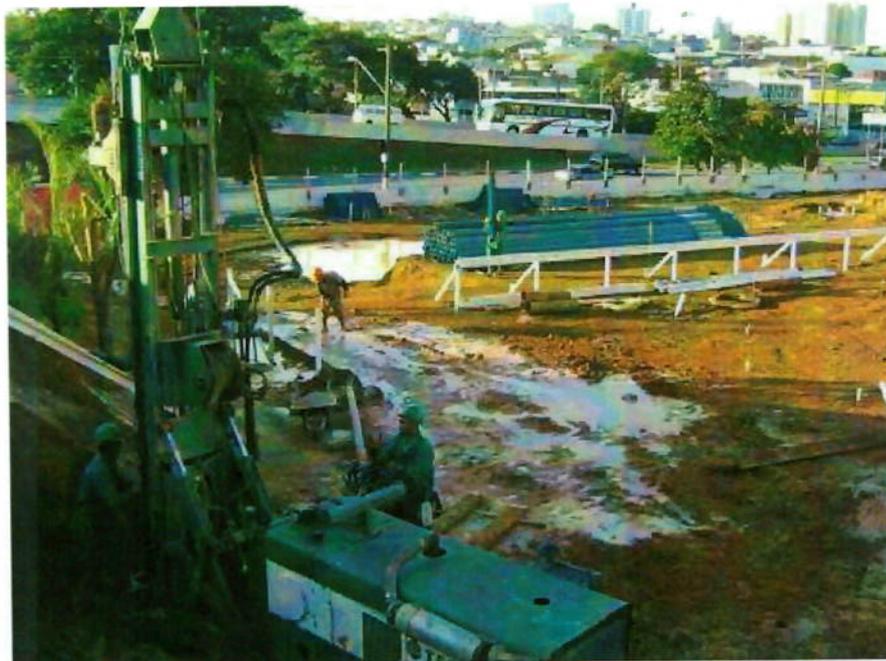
Equipamento de perfuração do terreno para instalação de tubos de dreno para rebaixamento do lençol freático.
